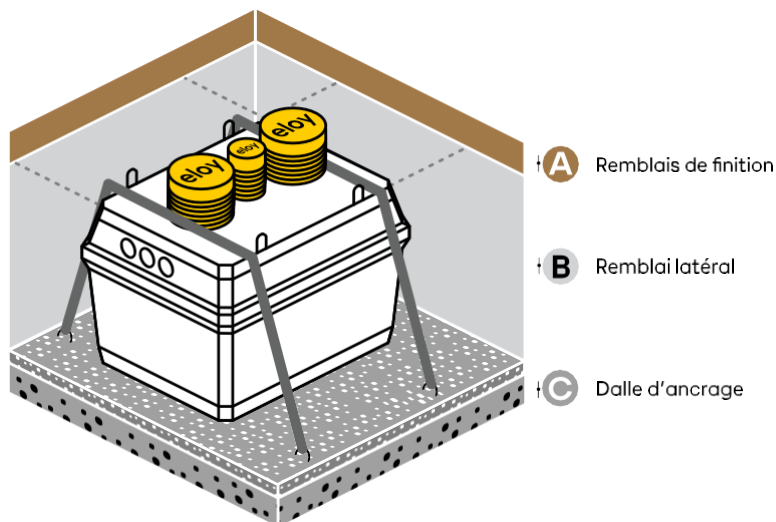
illustration d'une dalle d'ancrage (prévoir une couche de 5 cm de gravillon 2/4 ou 4/6 mm entre la dalle et la cuve)
